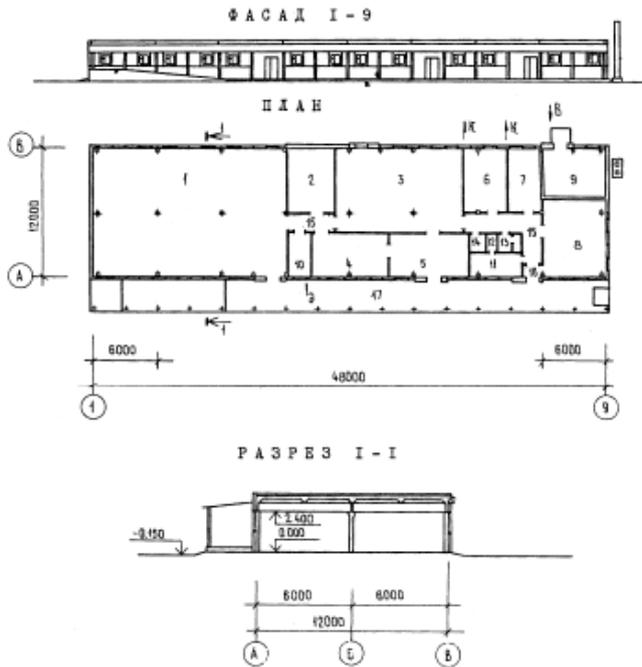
Производственный корпус для пчеловодческой фермы на 2 400 пчелиных семей (ТП 808-5-44.86): 1 – сотохранилище; 2 – термозал; 3 – помещение по обработке и расфасовке меда; 4 – помещение по переработке воскового сырья и ремонту инвентаря; 5 – склад готовой продукции; 6 – моечная; 7 – комната пчеловода; 8 – мастерская по ремонту пчеловодческого инвентаря; 9 – отопительная; 10 – электрокалориферная с электрощитовой; 11 – гардеробная; 12 – душевая; 13 – санузел; 14 – помещение хранения уборочного инвентаря; 15 – коридор; 16 – тамбур; 17 – рампа
